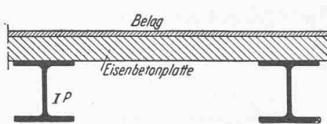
Schwerdecke aus Walzträgern und Eisenbetonplatte
